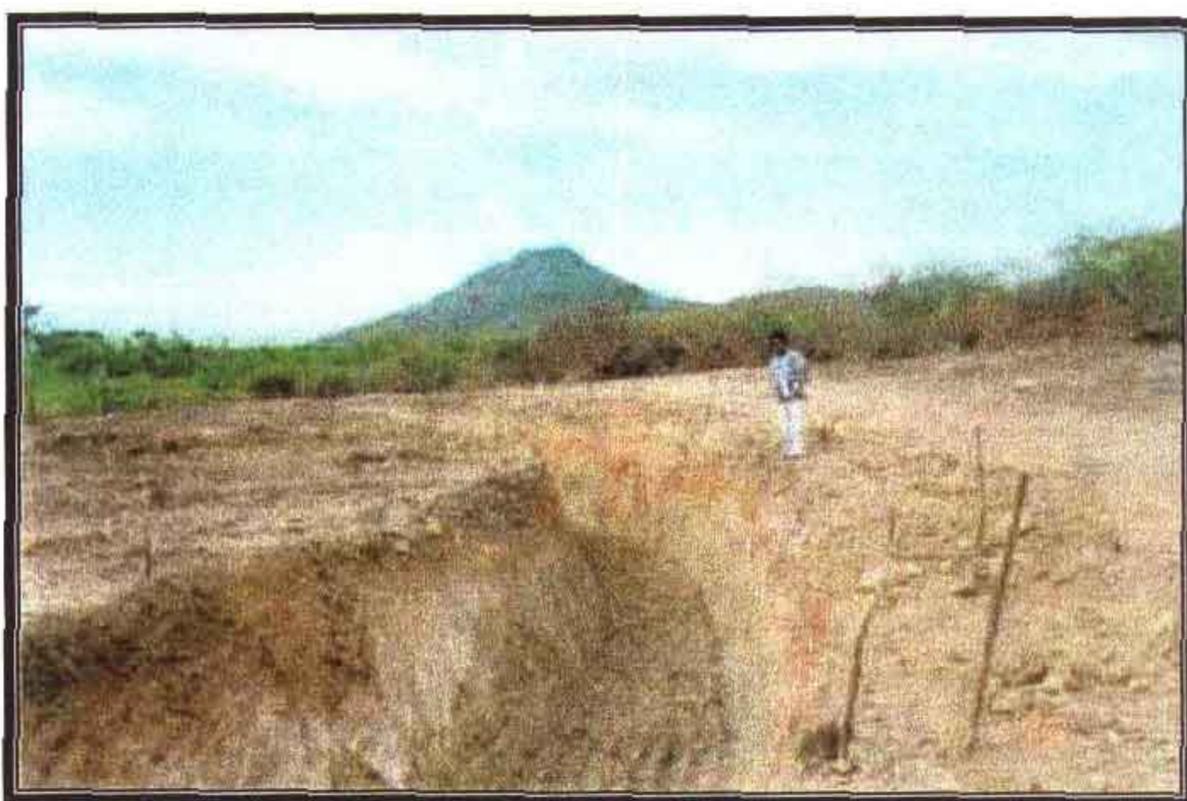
Tomada d'Água detalhe de escavação de montante.
